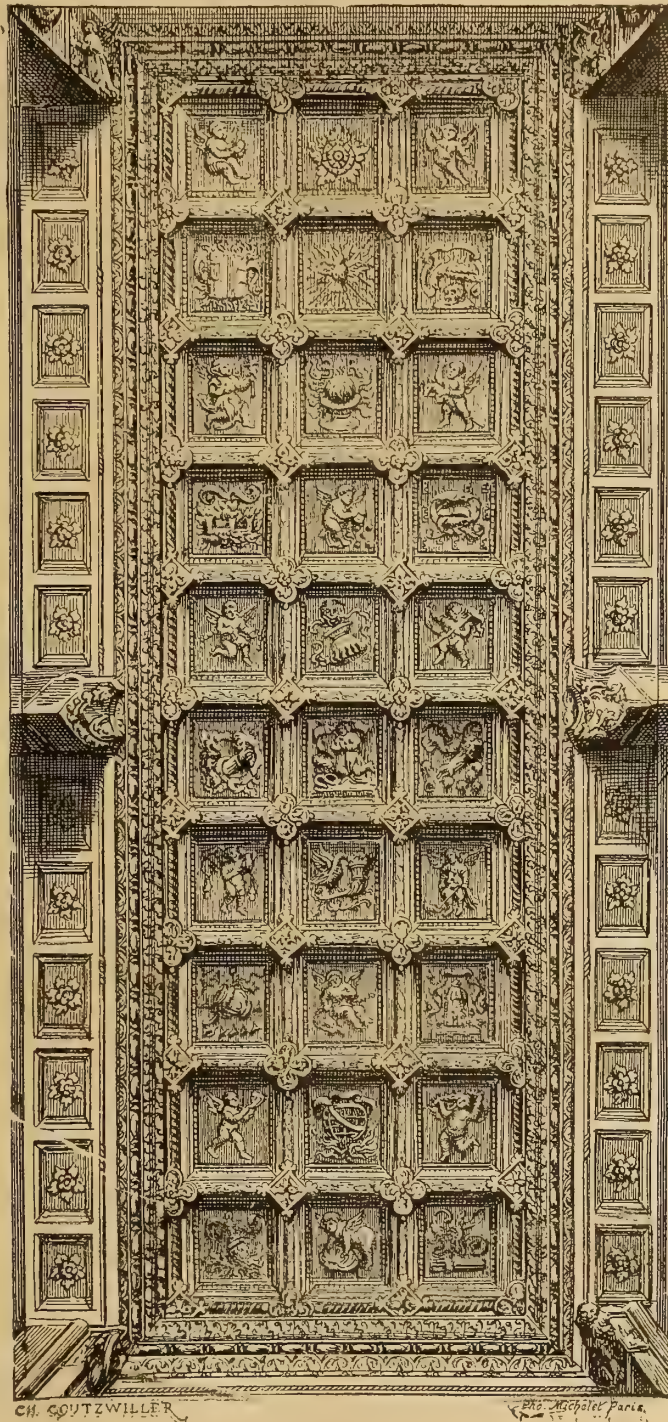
CAISSONS DANS UN PLAFOND DE STYLE RENAISSANCE
